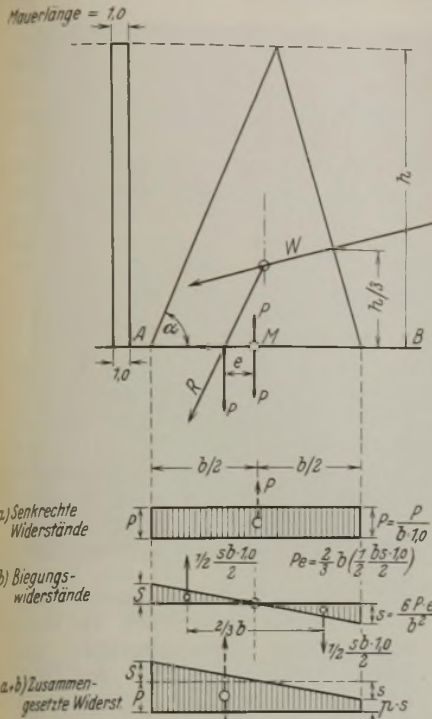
Das Trapezgesetz mißbräuchlich auf die Berechnung eines Stau-mauerquerschnitts angewendet.
